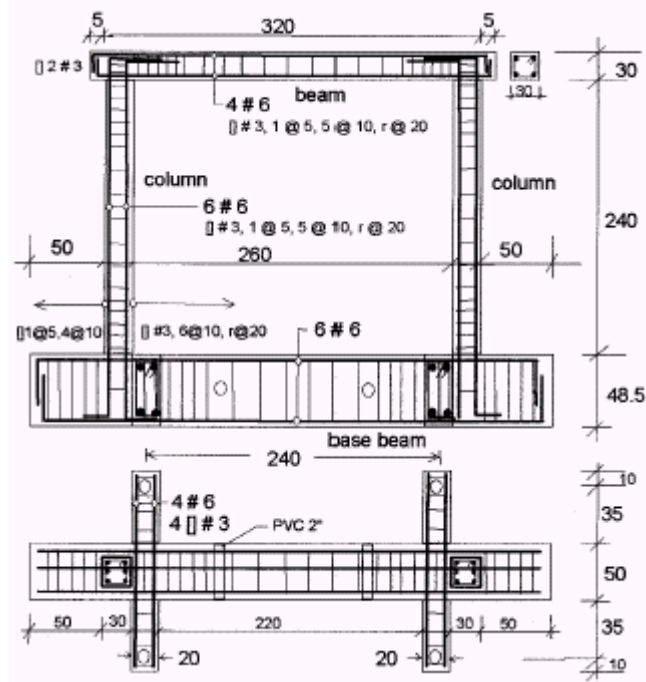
Dimensões do pórtico de concreto – extraída de Tumialan et al. (2003)
